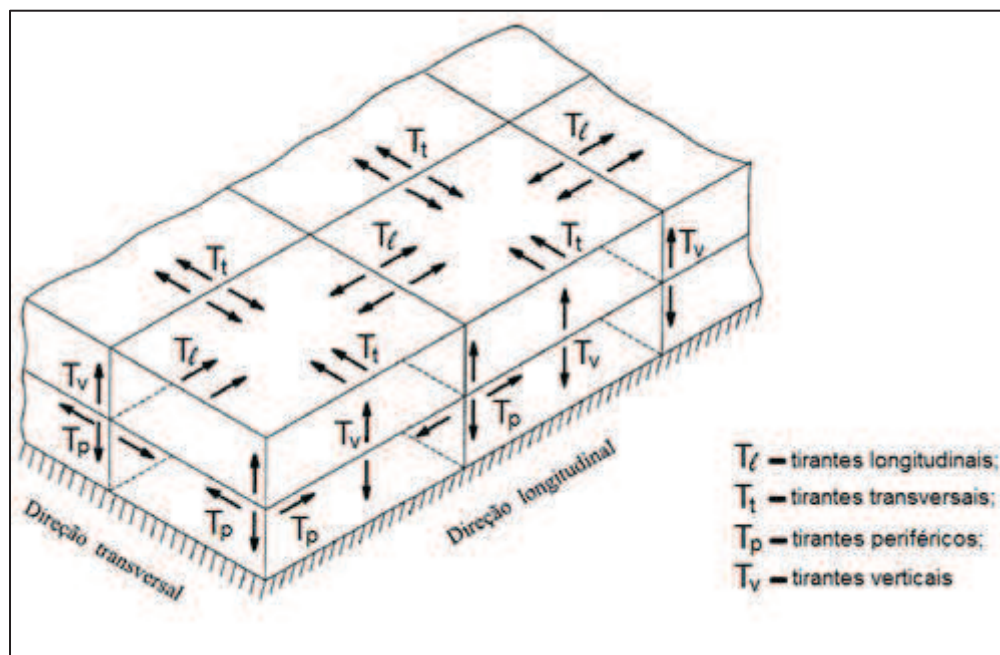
Arranjo dos tirantes para proteger contra colapso progressivo.
